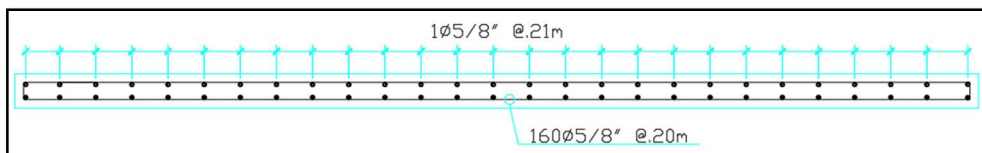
Distribución acero refuerzo de la losa o tablero 0.2 m x 5.60 m.
